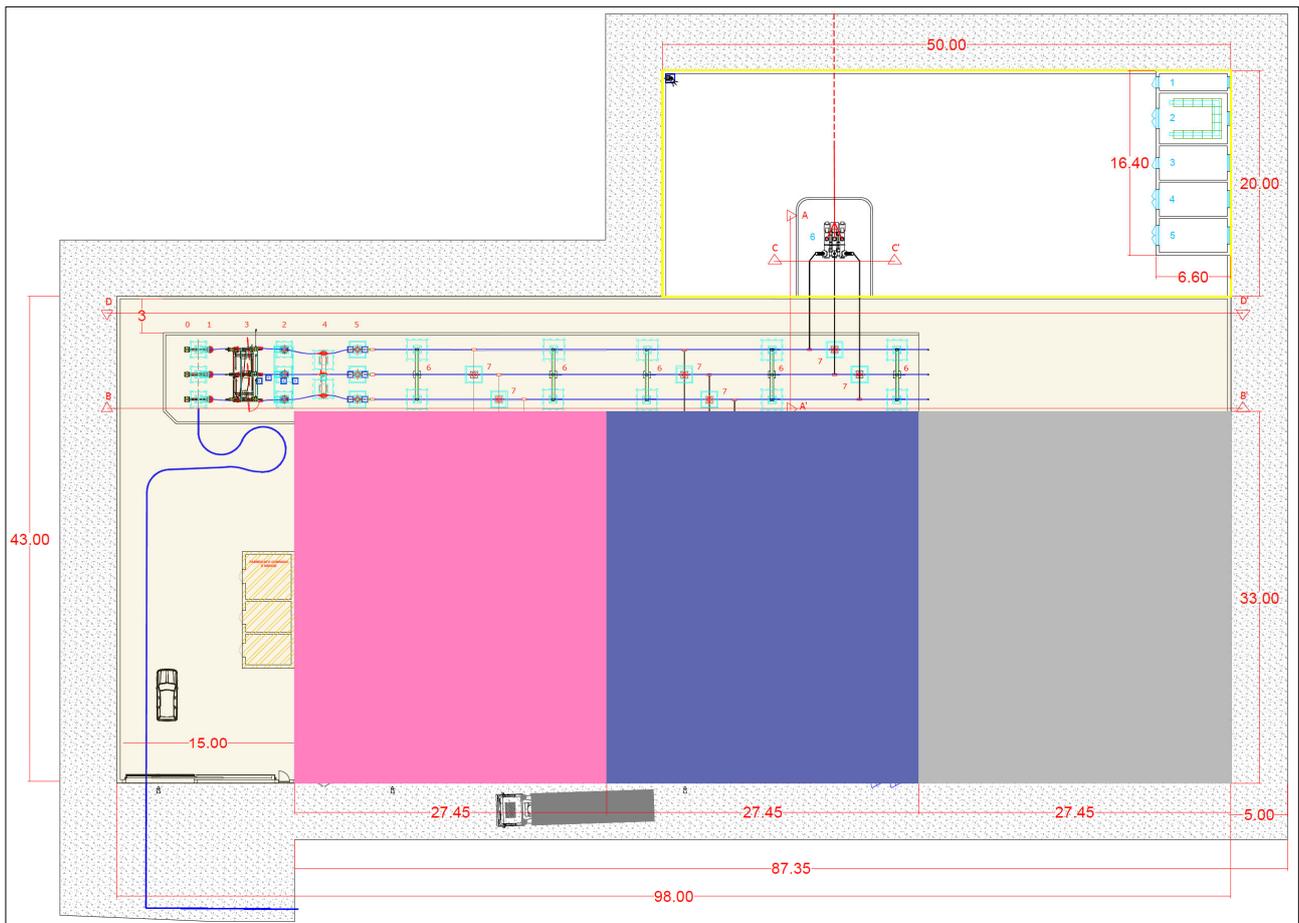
Planimetria elettromeccanica della Stazione Elettrica Condivisa
